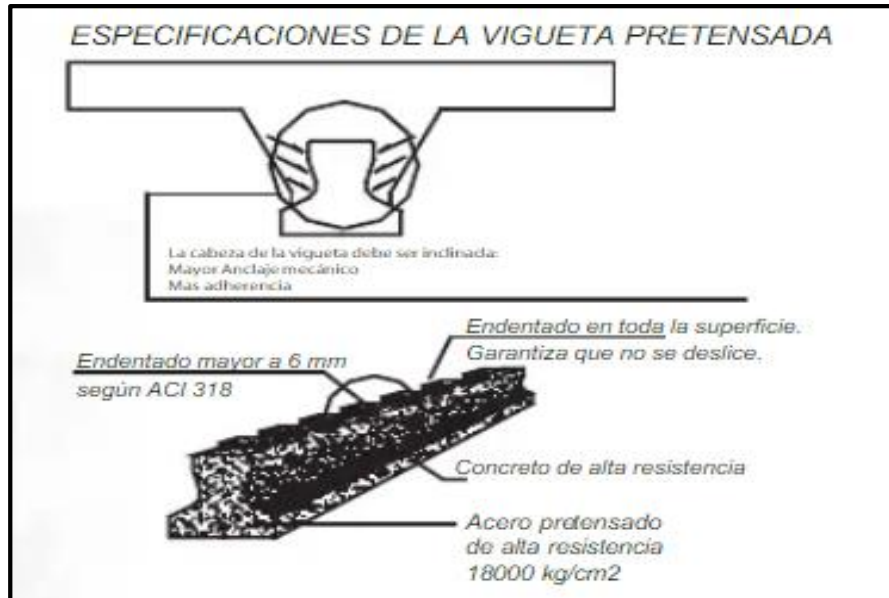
Detalle de anclaje de vigueta pretensada y losa in situ
